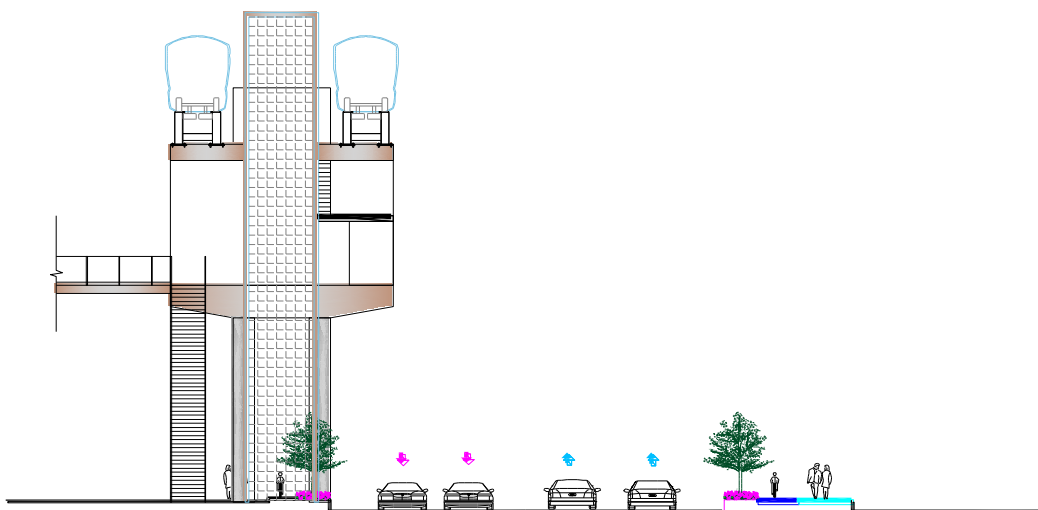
岛式车站（线间距 6.6m）剖面图
